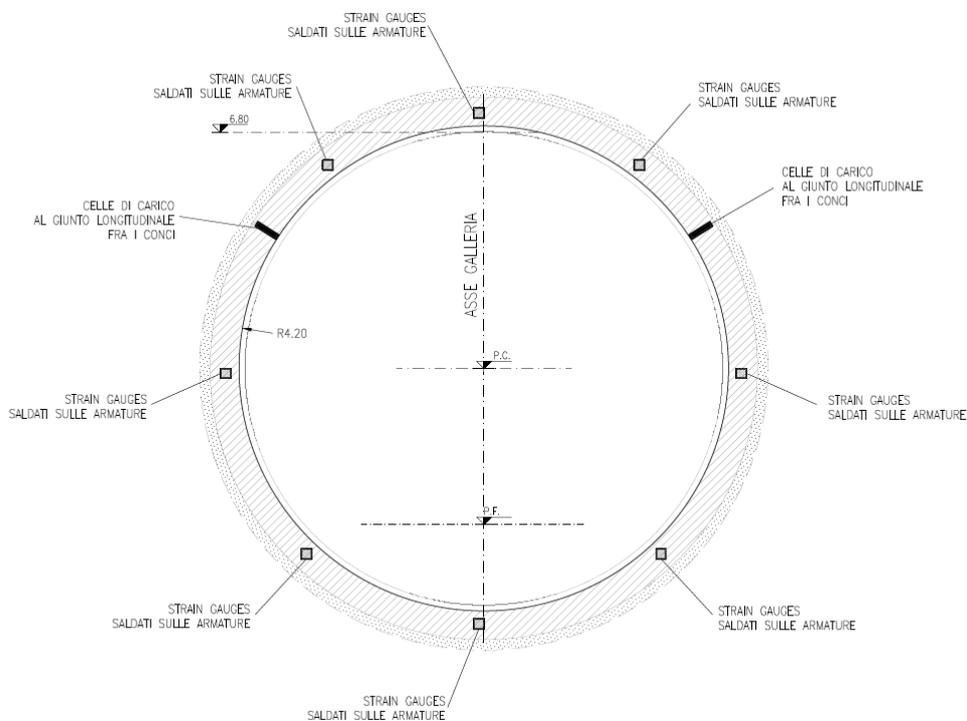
Esempio di stazione di misura dello stato tensionale (STAZIONE TIPO “B”)
